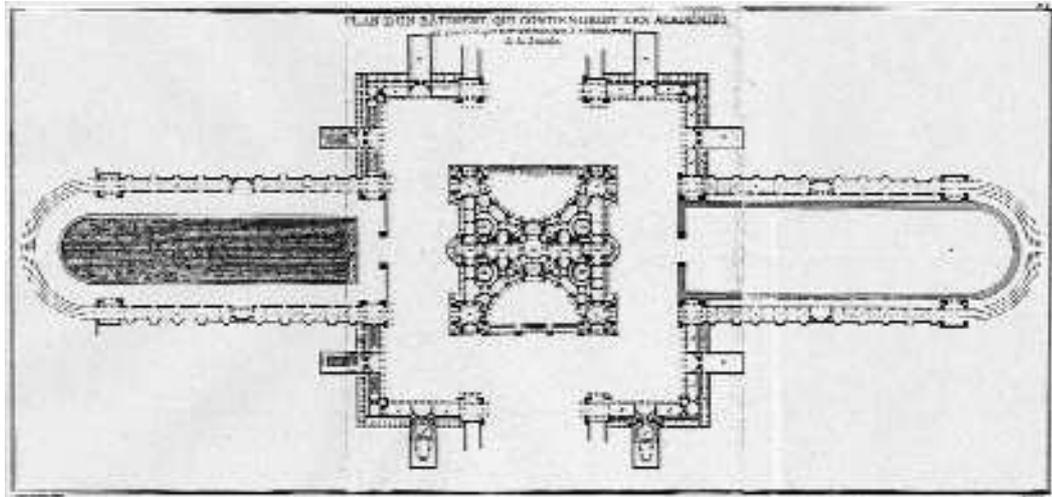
Peyre, Akademie, Grundriß, 1765 (entworfen nach 1753)
